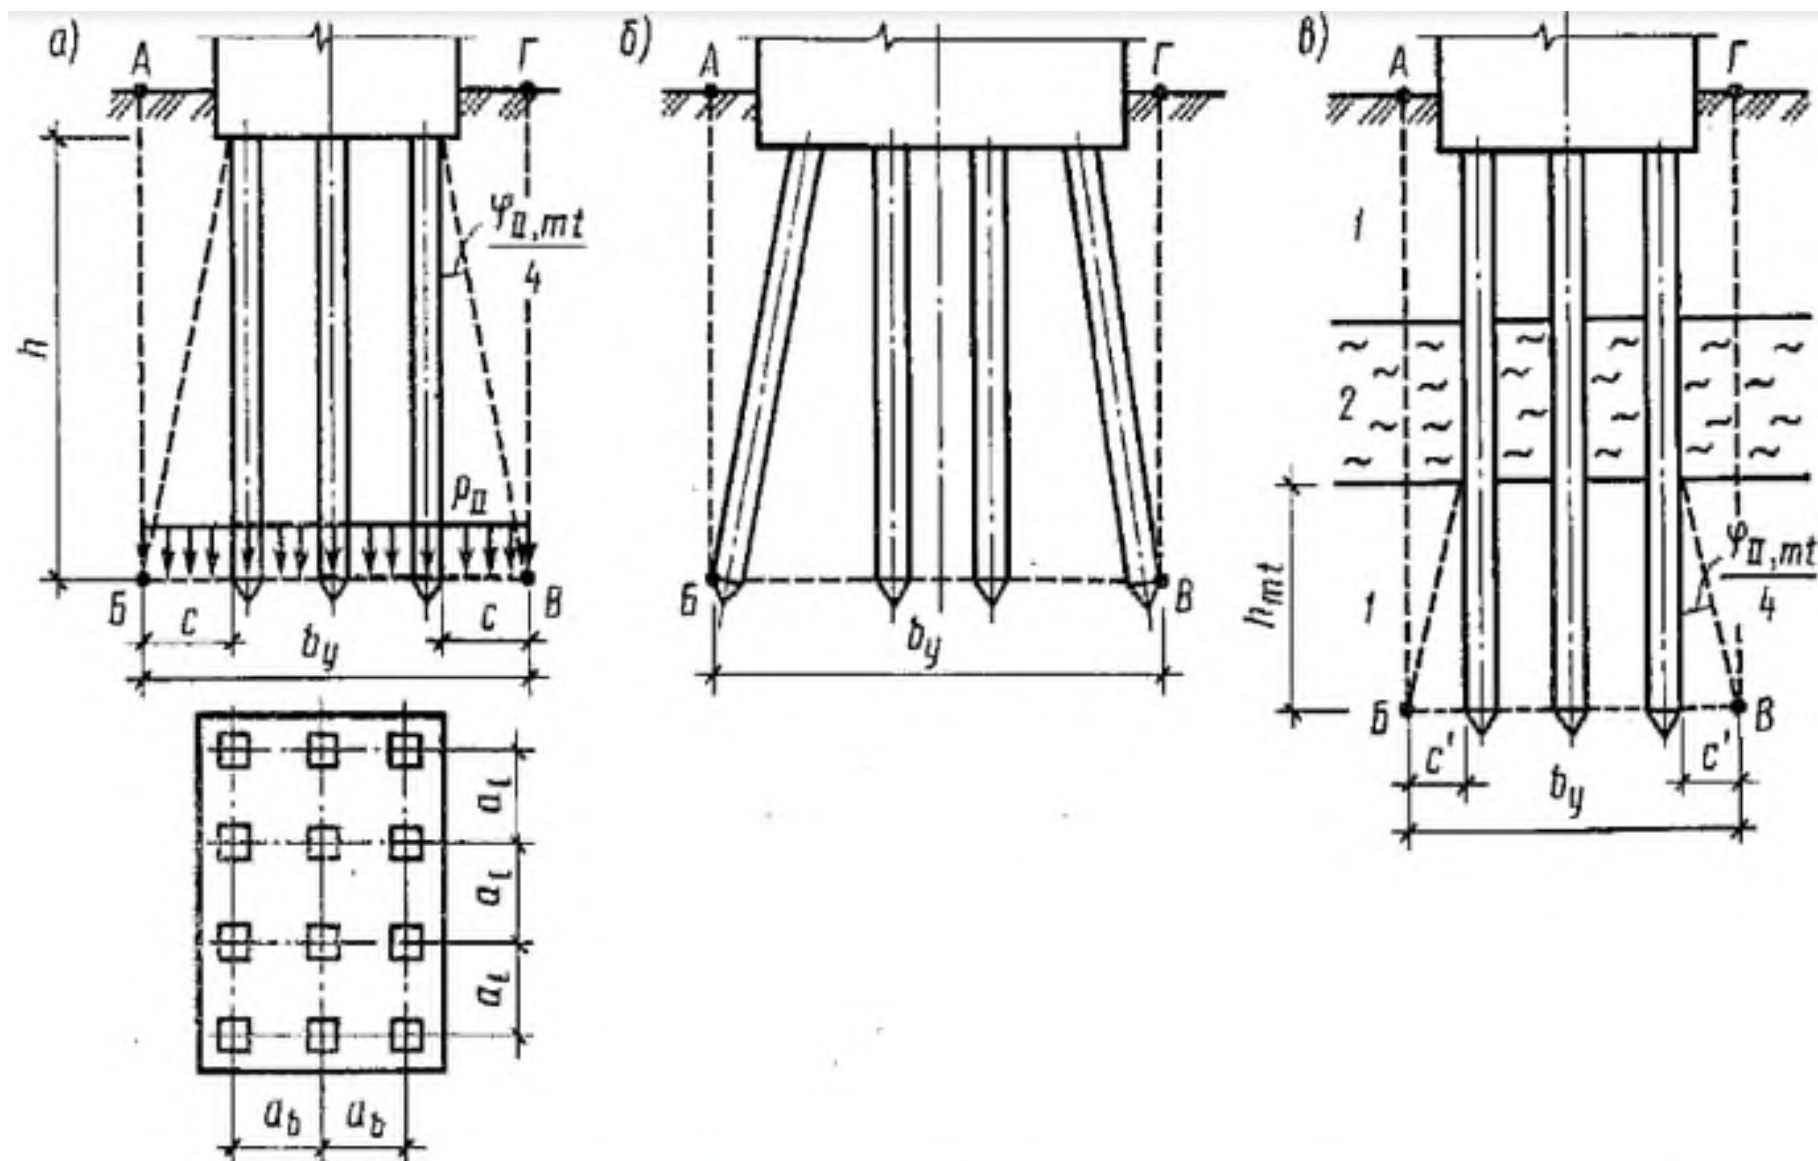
Схемы условных фундаментов для расчета по второй группе предельных состояний
